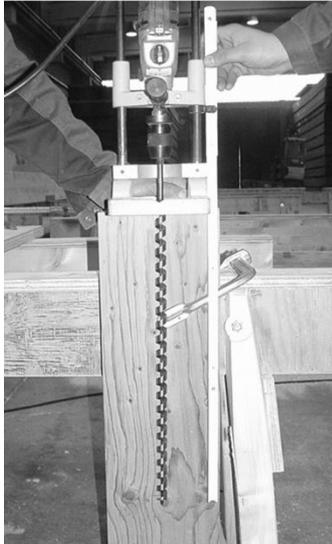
Stirnseitige Längsbohrung für eingeleimte Gewindestangen.
